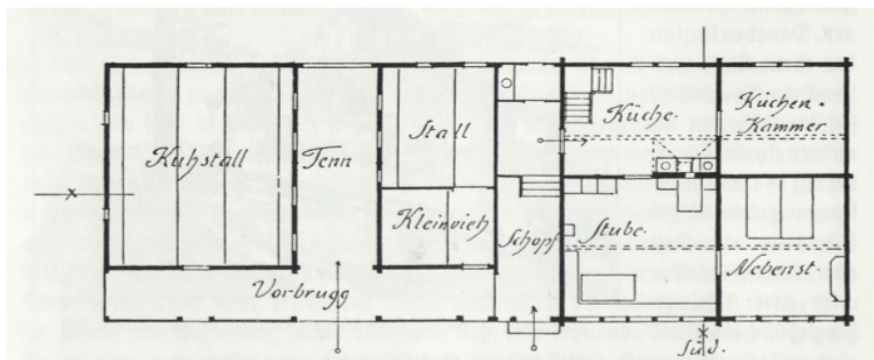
Grundriss eines grösseren Hauses mit Schönnenanbau
